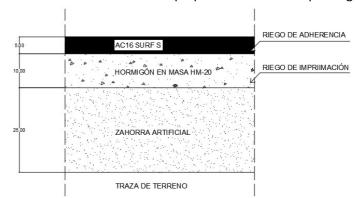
Sección transversal aparcamientos. Fuente: Elaboración propia.
